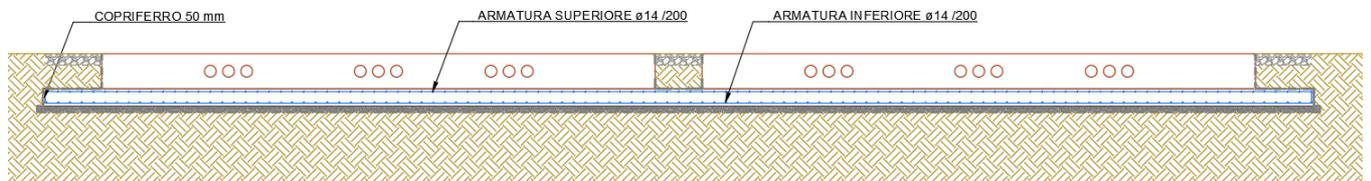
Sezione B-B della platea di fondazione della Cabina di Centrale
